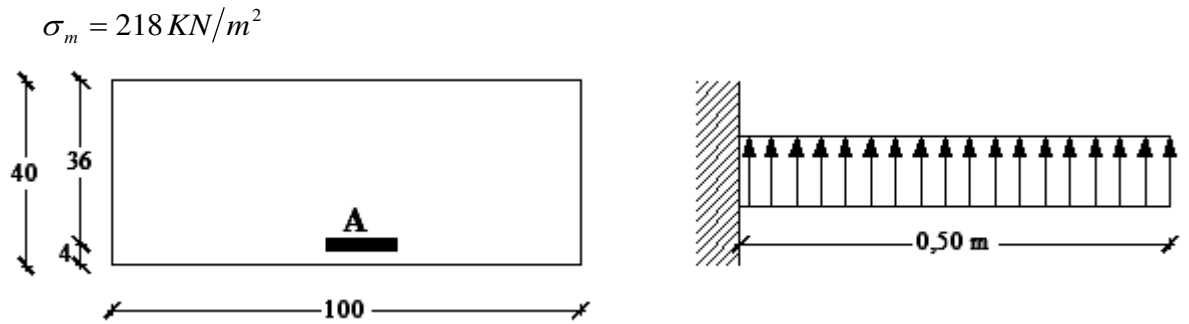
Schéma statique et section de calcul du débordement.
